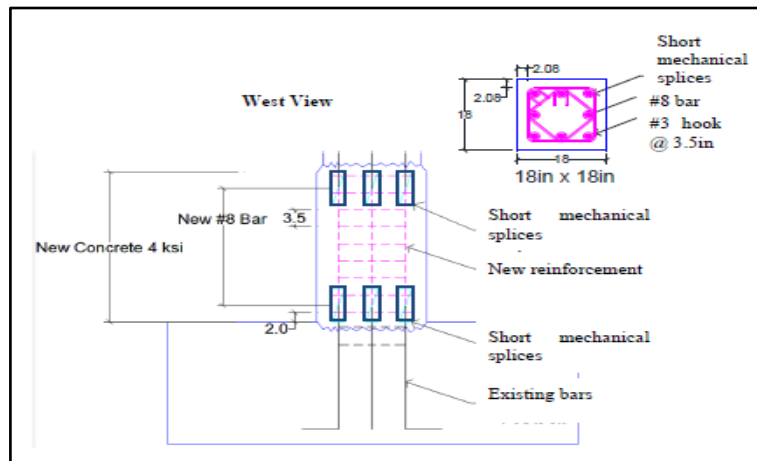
Detalles para el Reforzamiento en la parte inferior de la Columna.
